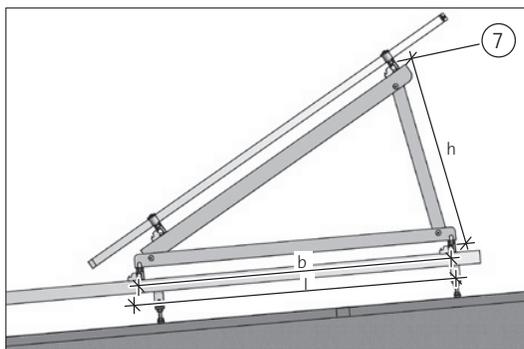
Vista lateral del marco de tejado plano tipo B
